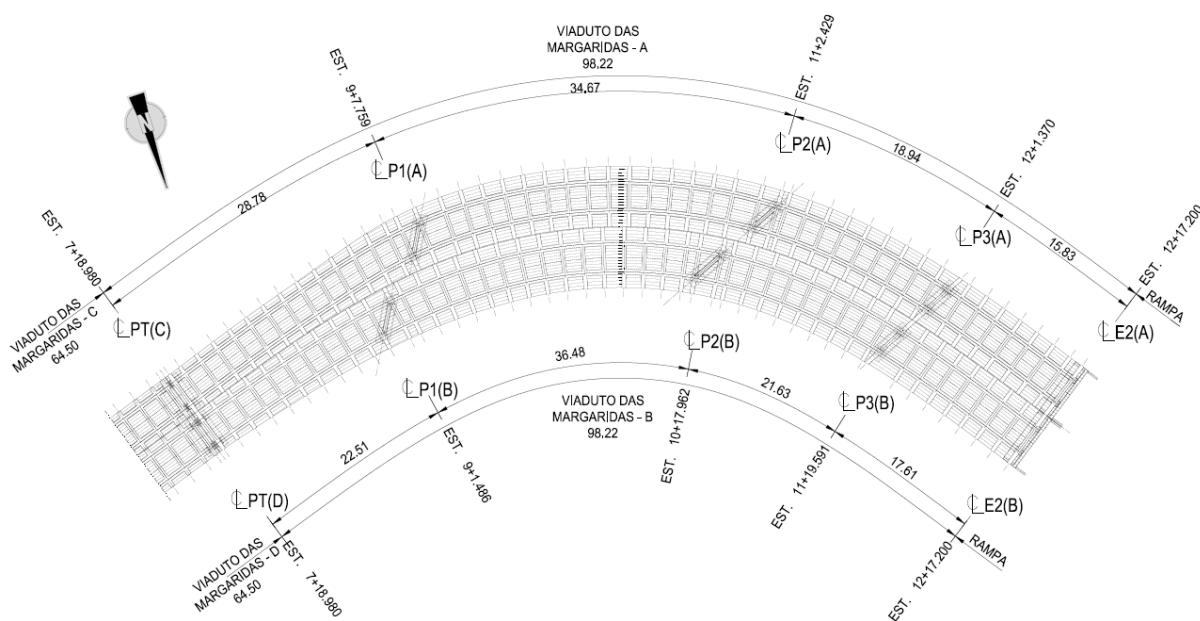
Viadutos das Margaridas A e B – planta superior.
